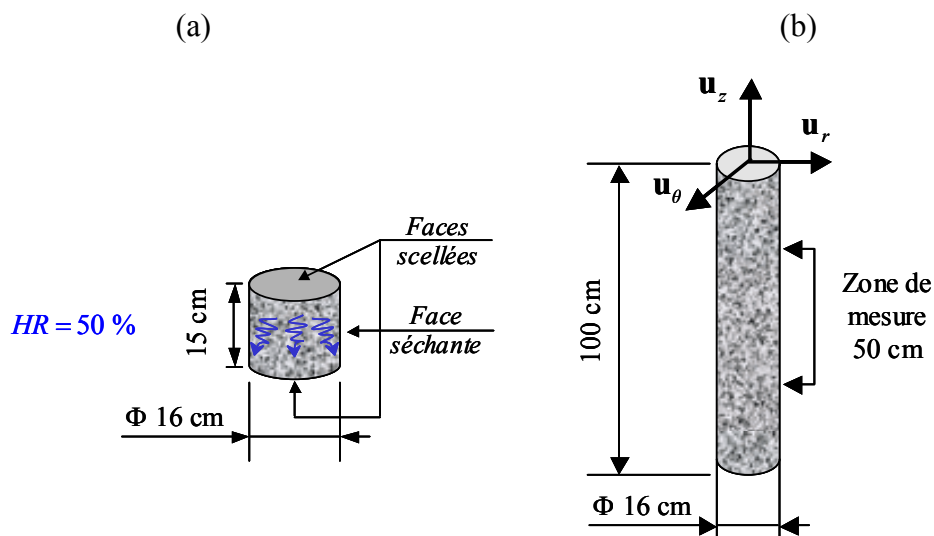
Conditions aux limites, géométrie des éprouvettes et principe de mesure.
